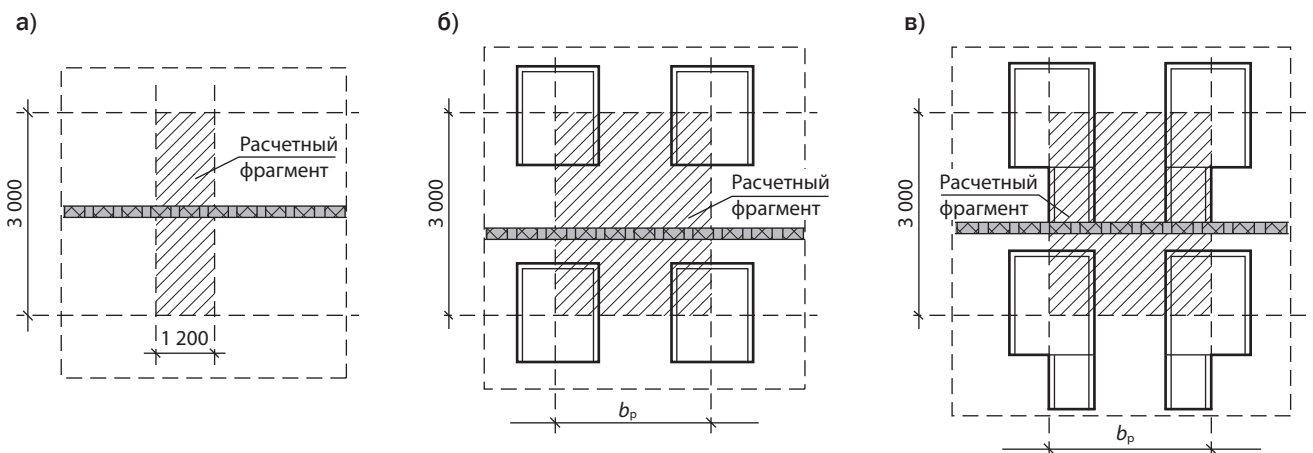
Схемы расчетных фрагментов наружной двухслойной стены
